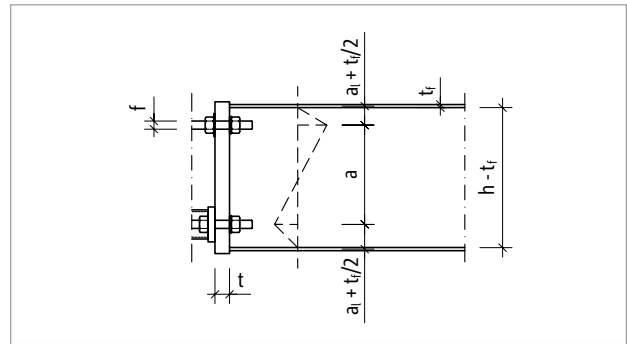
Plaque frontale affleurante T type S : tableau de valeurs de départ géométriques ; coupe
